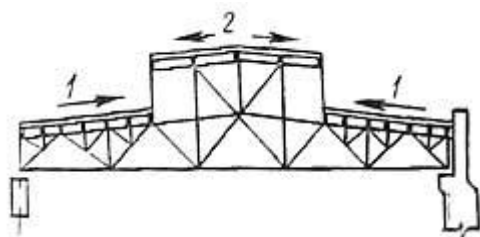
Последовательность укладки плит покрытий на металлические фермы
